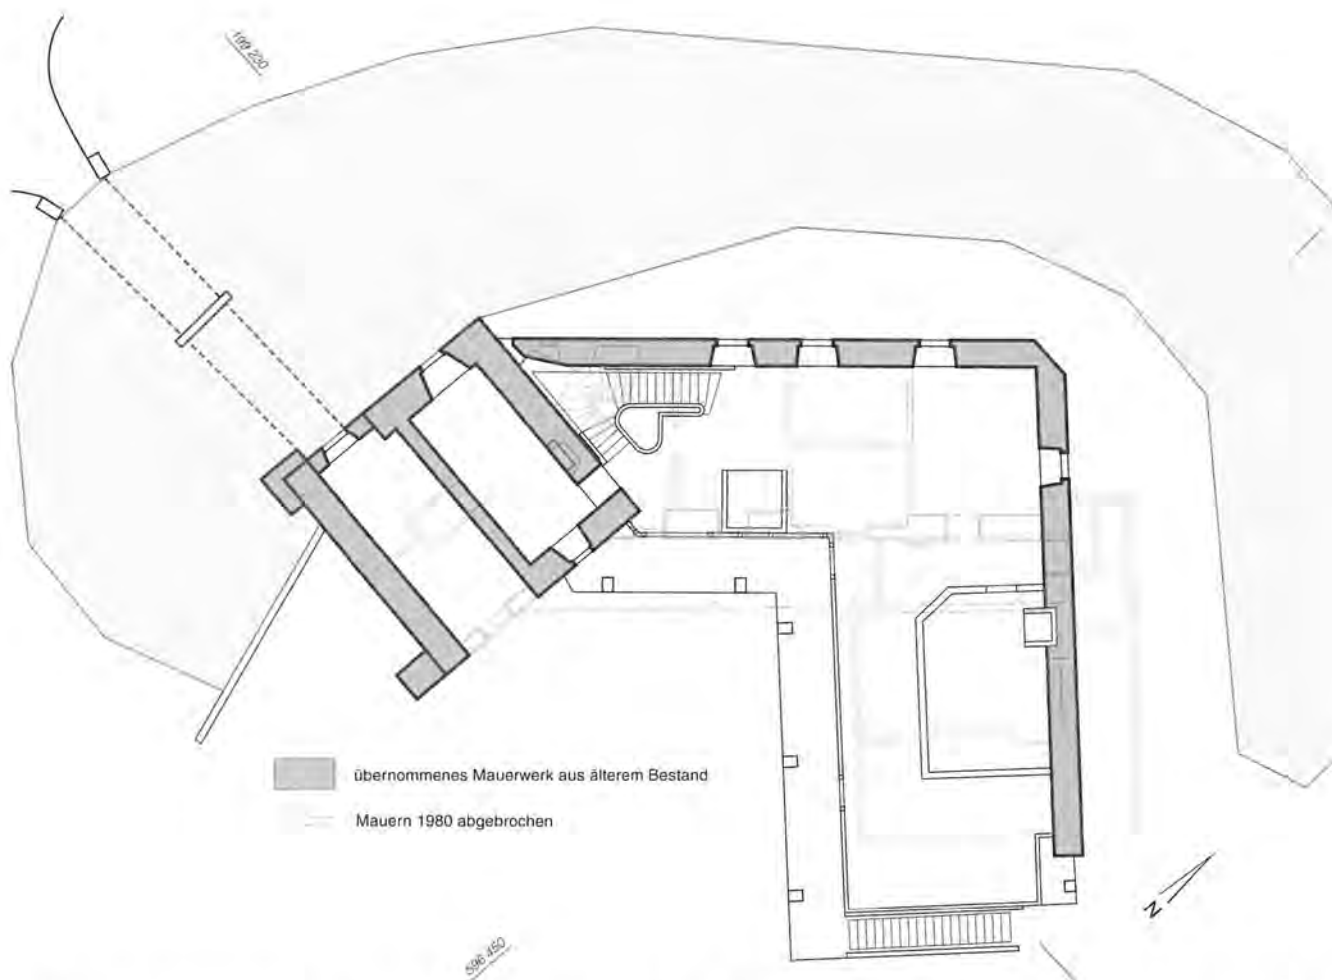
Bauphasenplan Neuzeit. Bestand nach Sanierung 1979/1980: Sanierung des Torturms, Neubau Hoftrakt unter Verwendung der alten Aussenfassade und Erkerrekonstruktion, mit Cafeteria im Erdgeschoss, Saal des Schlossvereins und Musikschule des städtischen Konservatoriums in den Obergeschossen, 1983 16 Parkplätze, 1986 Restaurantküche, 1996 Sonnen- und Regenstoren für die Gartenwirtschaft.
